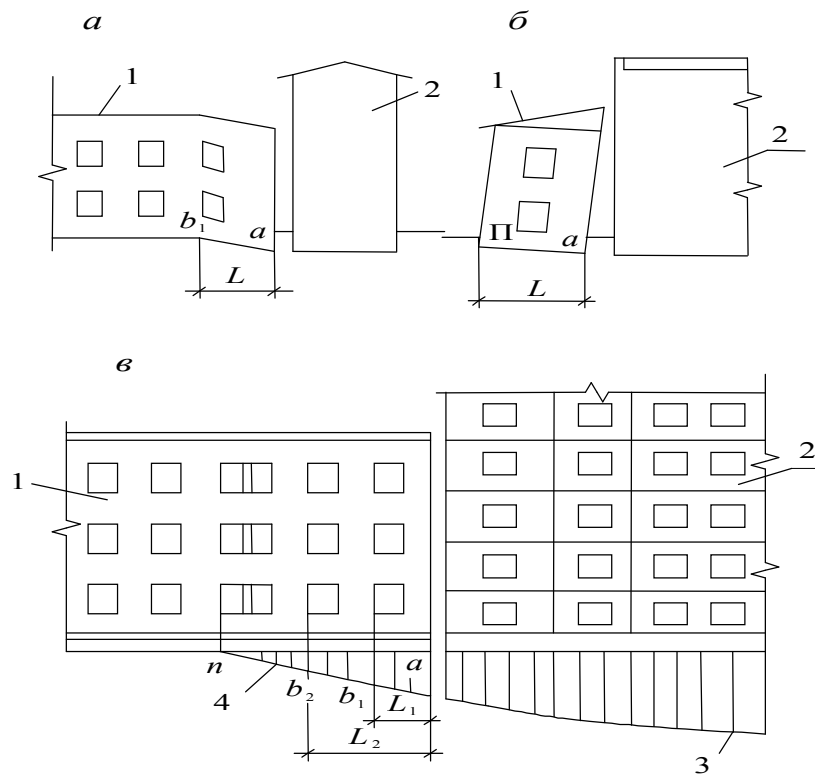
Схема визначення крену будівлі і перекосу його конструкцій в результаті розвитку додаткової осаді: *a* – перекіс конструкцій будівлі; *б* – крен щодо споруджуваної будівлі; *в* – епюра осаді поздовжньої стіни нової будівлі і додаткового осаді існуючої будівлі; *1* – існуюча будівля; *2* – яка будується; *3* – крива осаді нової будівлі; *4* – крива додаткового осаді старої будівлі від нової будівлі-прибудови
